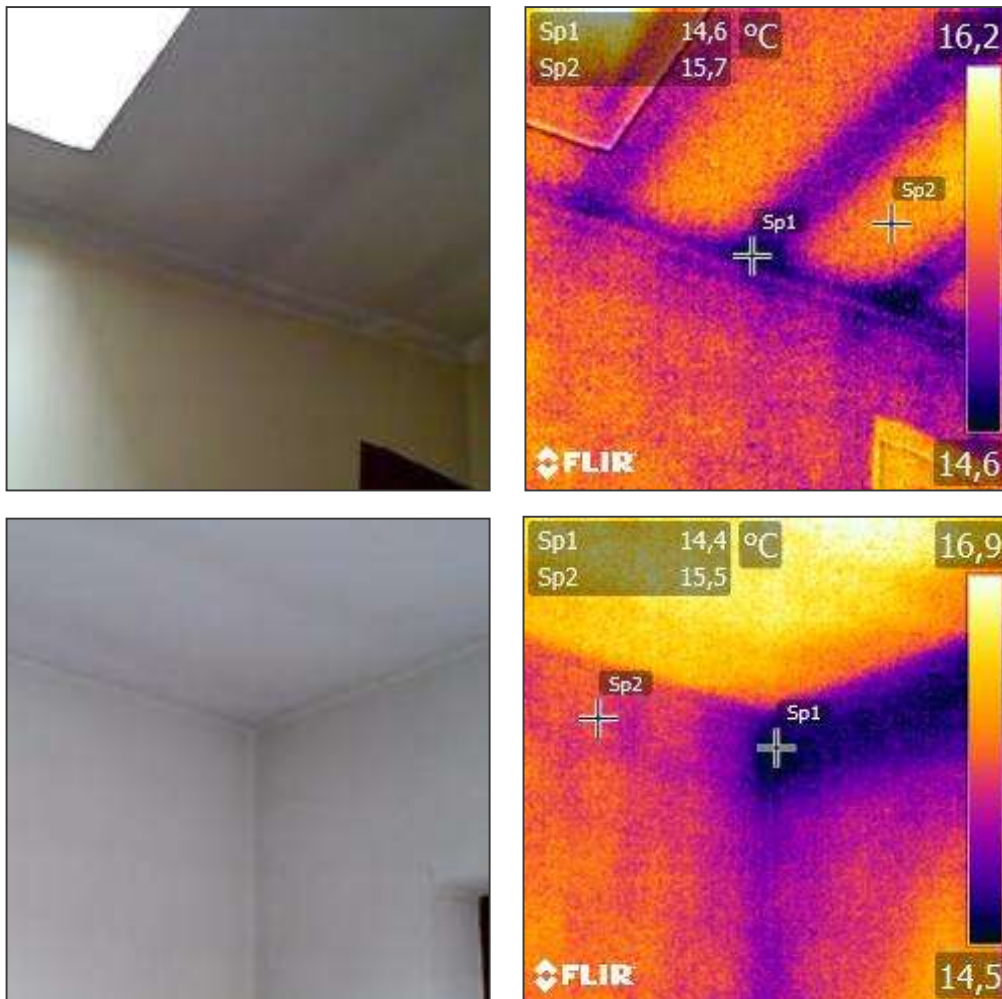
Pontes térmicas entre as vigas e a laje de cobertura e na própria laje
